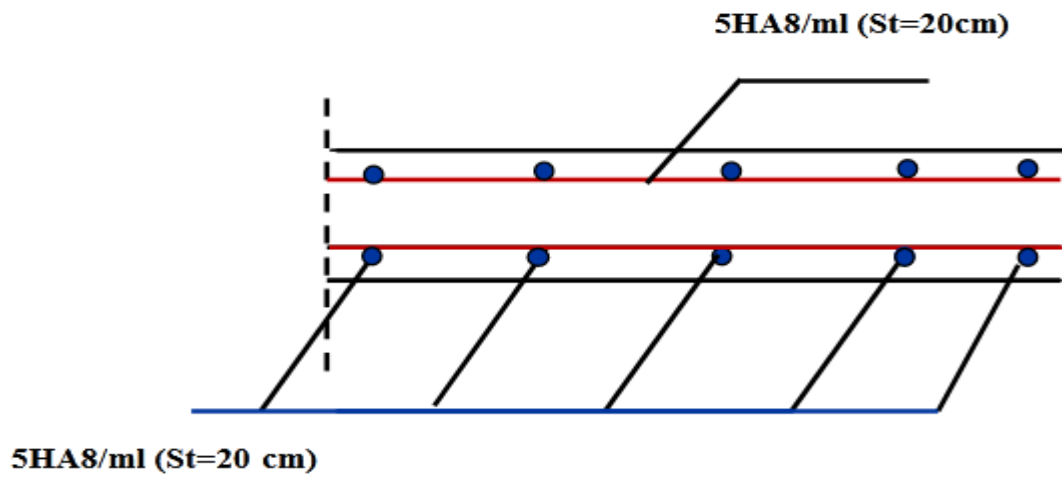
19: Schéma de Ferrailage pour les dalles pleines
